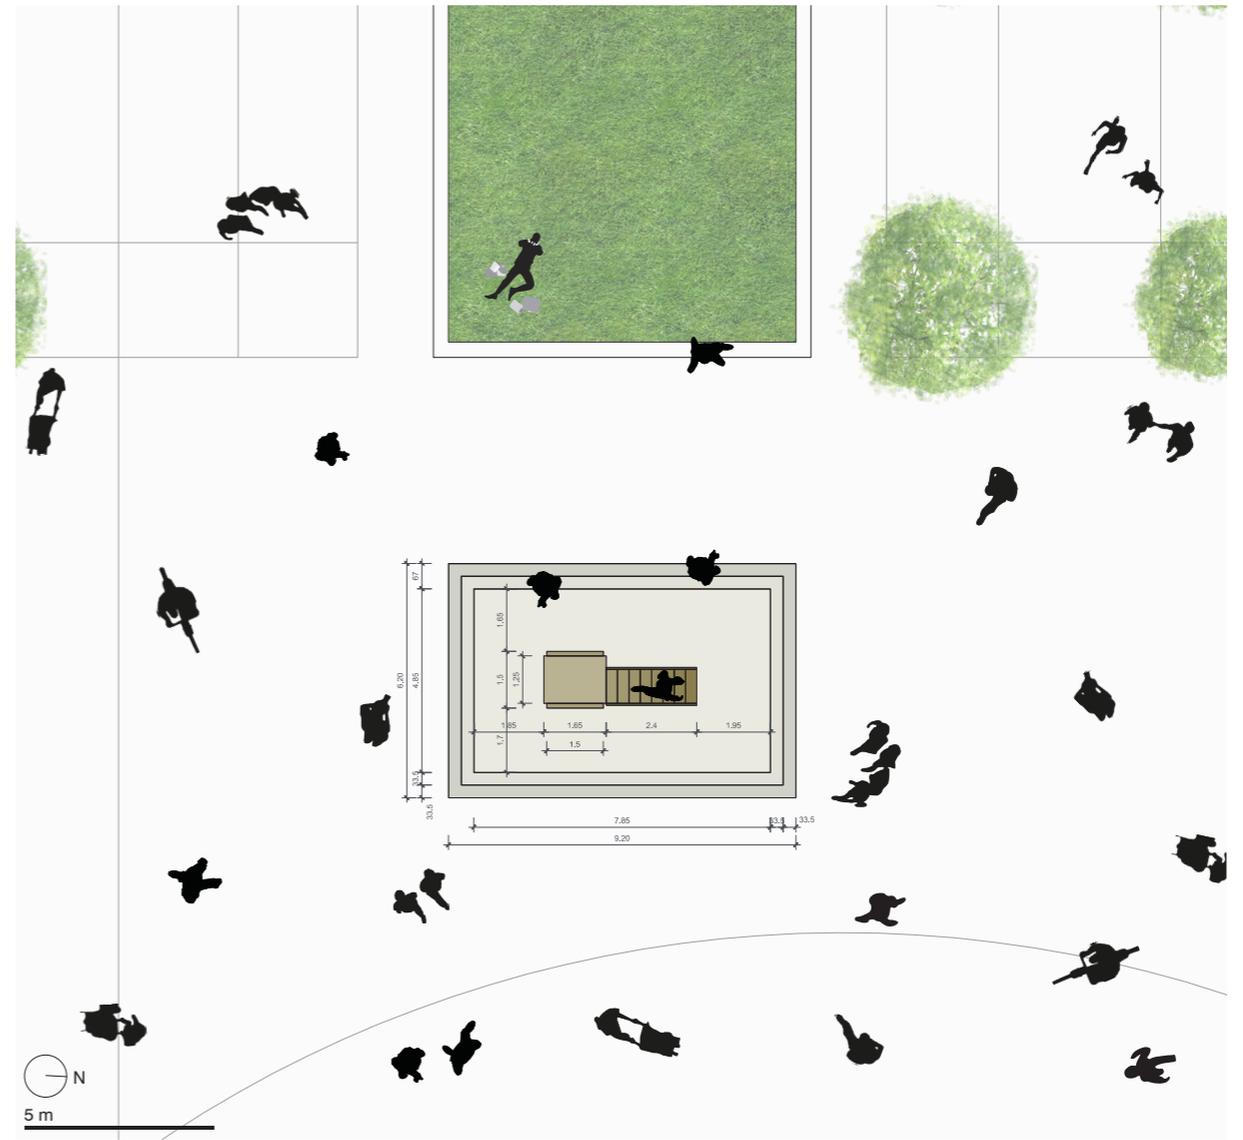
Grundriss Columbusplatz mit Hochstand 1:200
